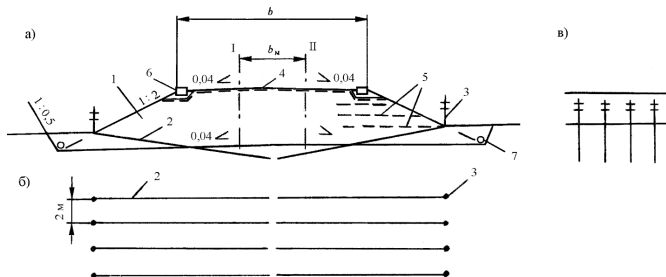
Схема конструкции насыпи на вечномёрзлых грунтах III – IV типов с заменой этих грунтов на дренирующие с охлаждающими устройствами: а) поперечный профиль; б) план; в) продольный разрез; 1 – защитный слой из дренирующего грунта; 2 – испаритель; 3 – конденсатор; 4 – нетканый материал и геосетка из базальтоволокна на основной площадке; 5 – геосетка из базальтоволокна в защитном слое; 6 – лоток для кабелей; 7 – продольный дренаж
